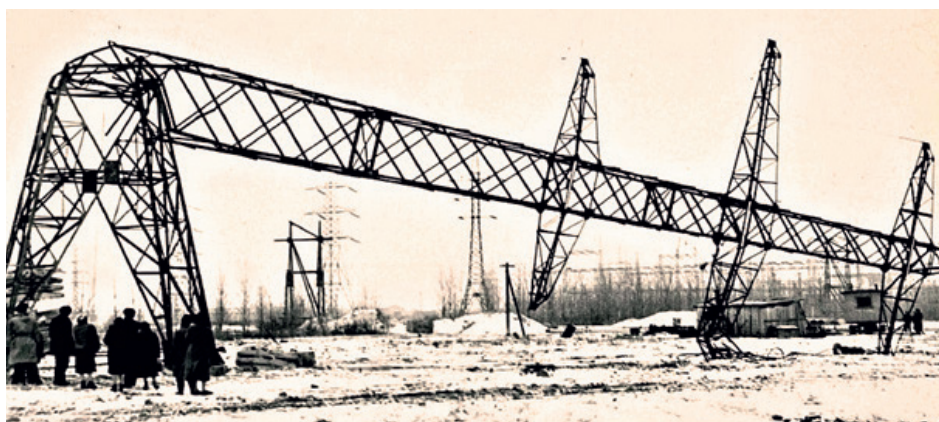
Натурные испытания до разрушения промежуточной двухцепной стальной опоры со сварными транспортабельными секциями ВЛ 110 кВ на деформативных односвайных фундаментах (1954)
